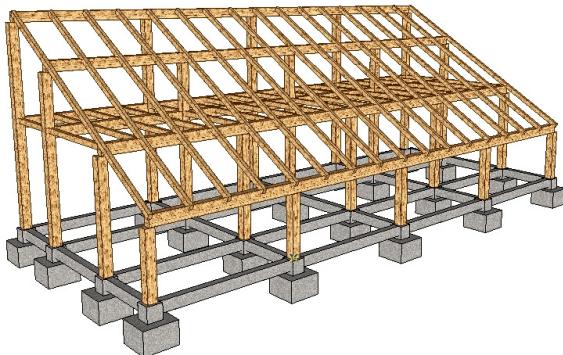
Structură pe cadre tradiționale din lemn realizată din stâlpi, grinzi și căpriori/Conventional wood frame strength structures made of pillars, beams and rafters
